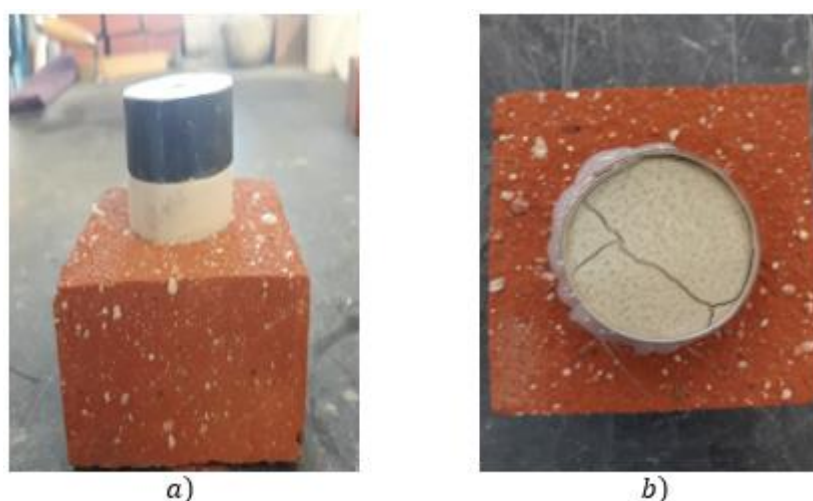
a) aplicação da pastilha metálica; b) fissura na pastilha da calda CHL.
